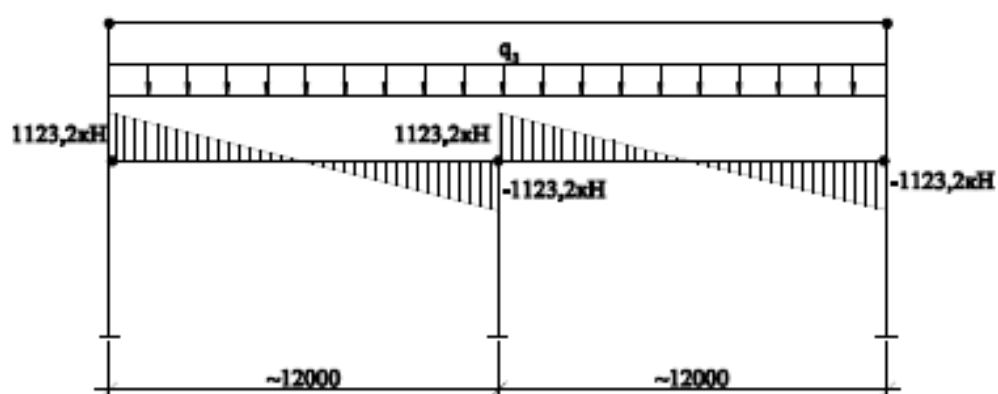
Эпюры усилий в раме от ветровой нагрузки
